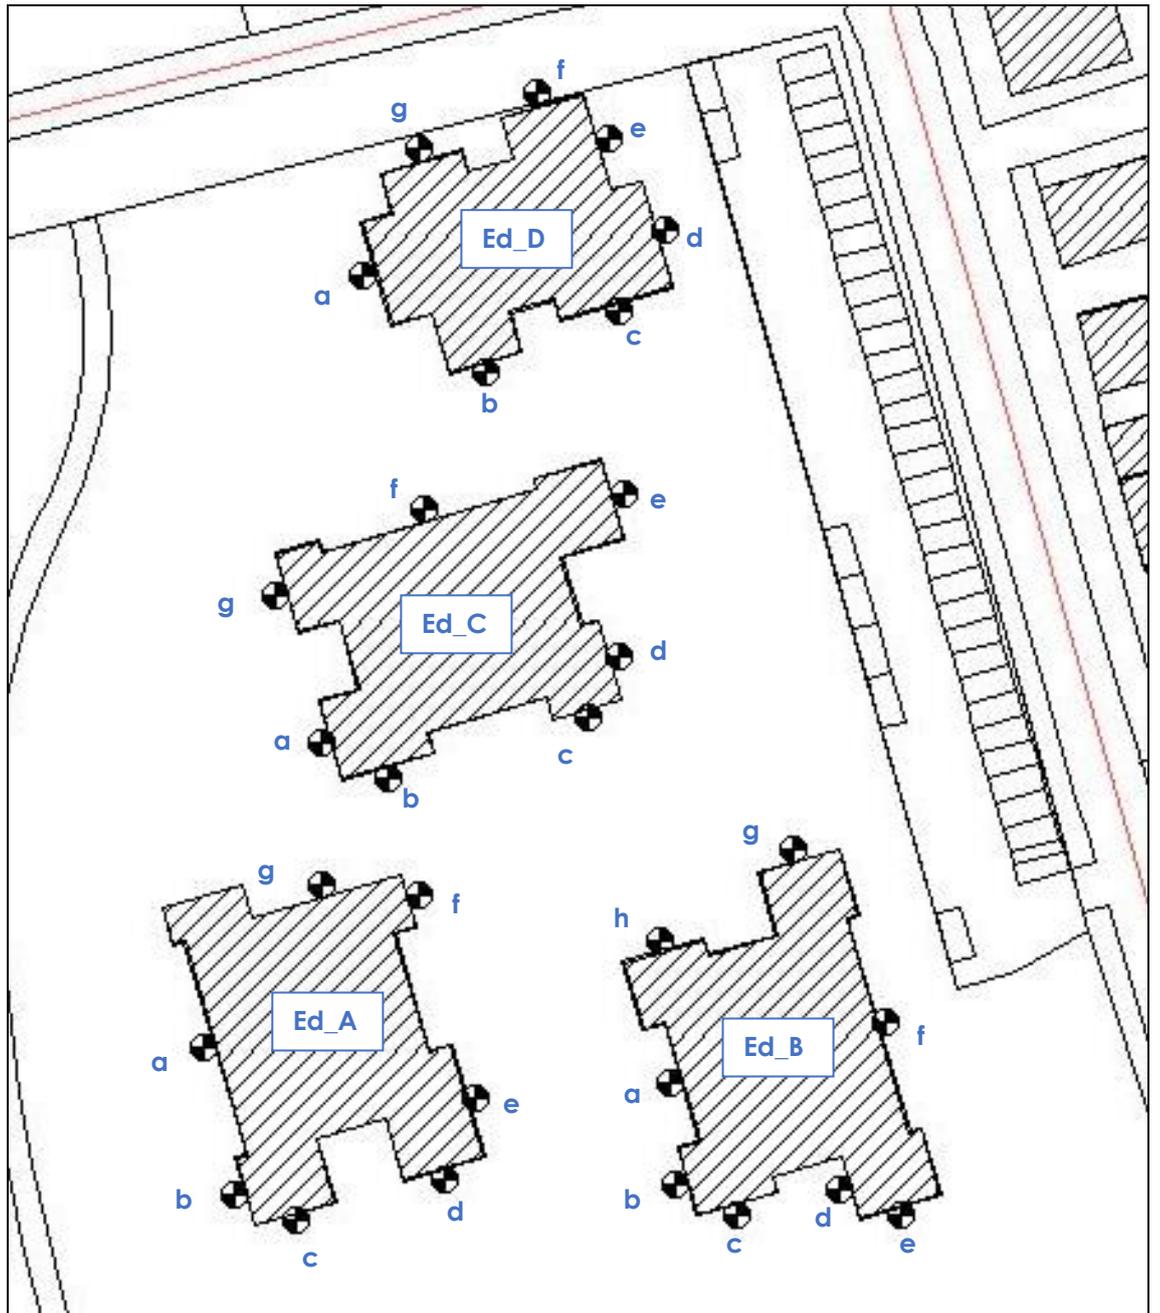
Nomi attribuiti alle facciate degli edifici in progetto e individuazione dei ricettori considerati sulla planimetria
